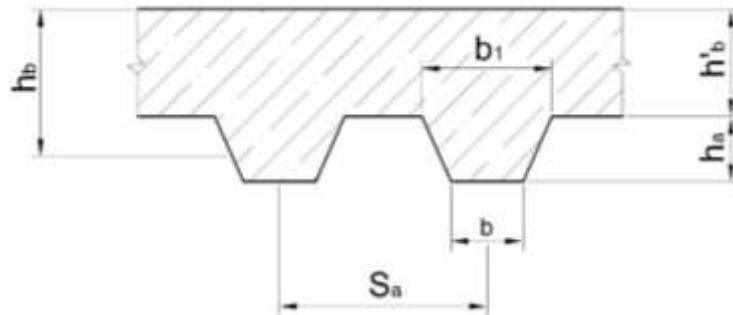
Поперечное сечение плиты перекрытия
